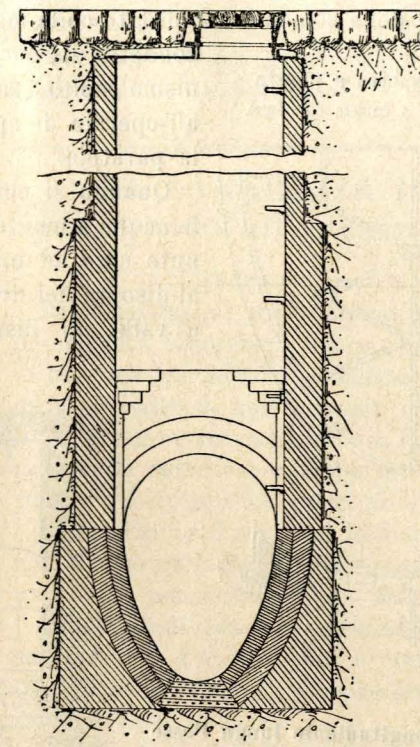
Sezione orizzontale di un pozzo d'ispezione.
